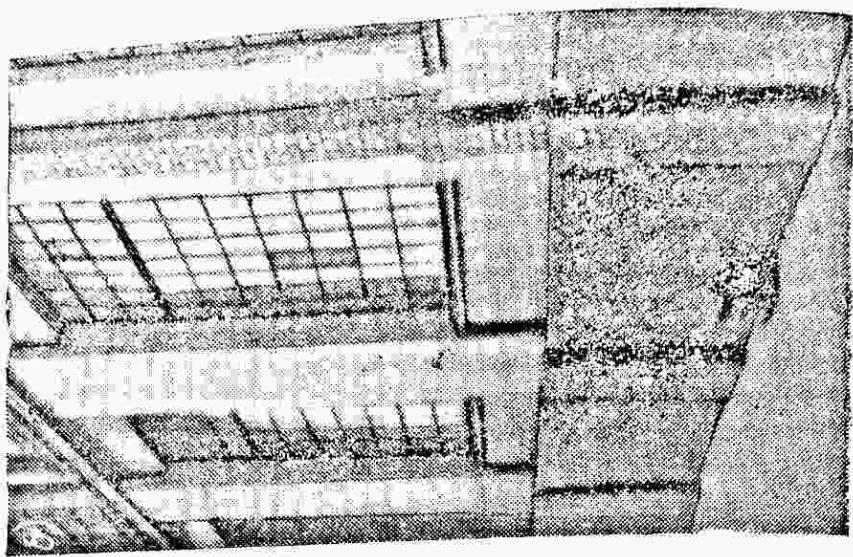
Прогиб наружной стены машинного здания Венгерской текстильной фабрики
